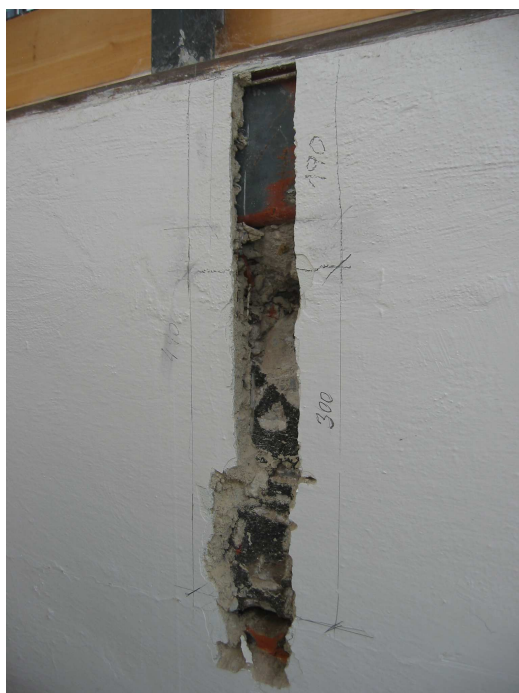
Sonda ke skladbě stropní konstrukce nad tiskárnou (bývalá restaurace) – vzhledem k technologii pod stropem nebylo možné realizovat průvrt
